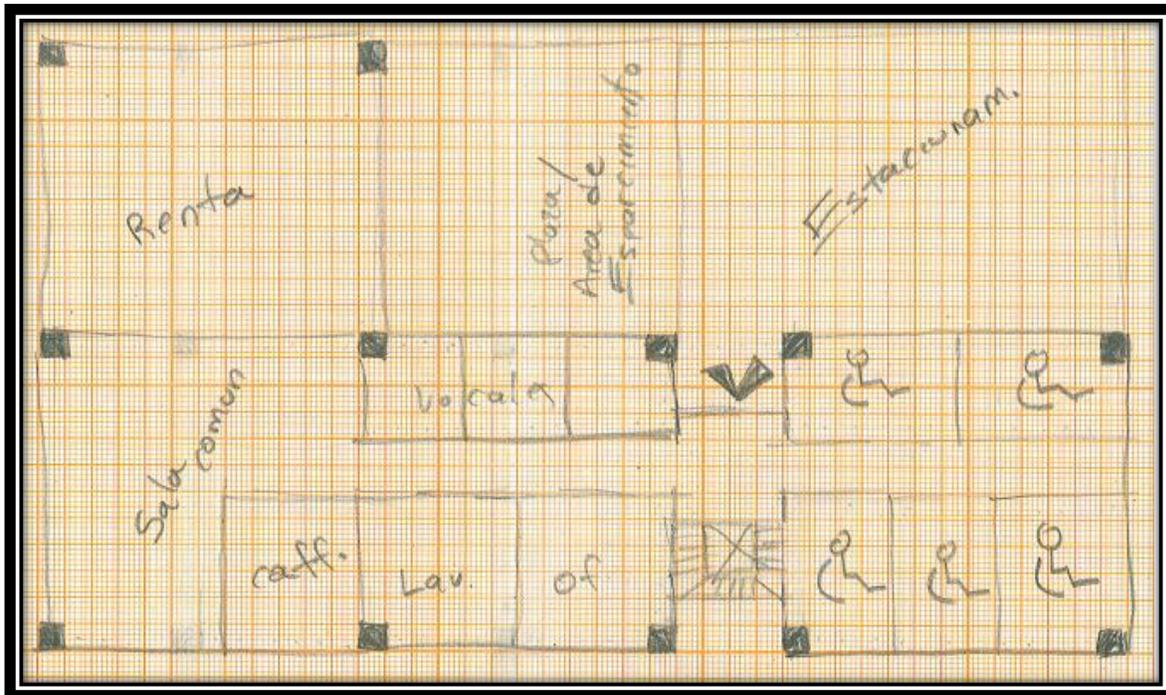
Boceto de la que fuera la primera planta baja, con la respectiva modulación de columnas. Nótese la distribución muy similar al proyecto final.
